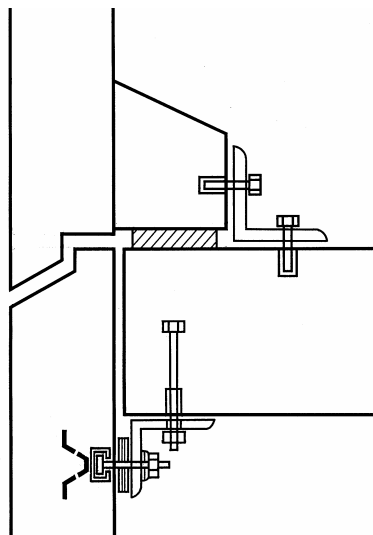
Ligações de tração por meio de chumbadores para painéis de fachada
